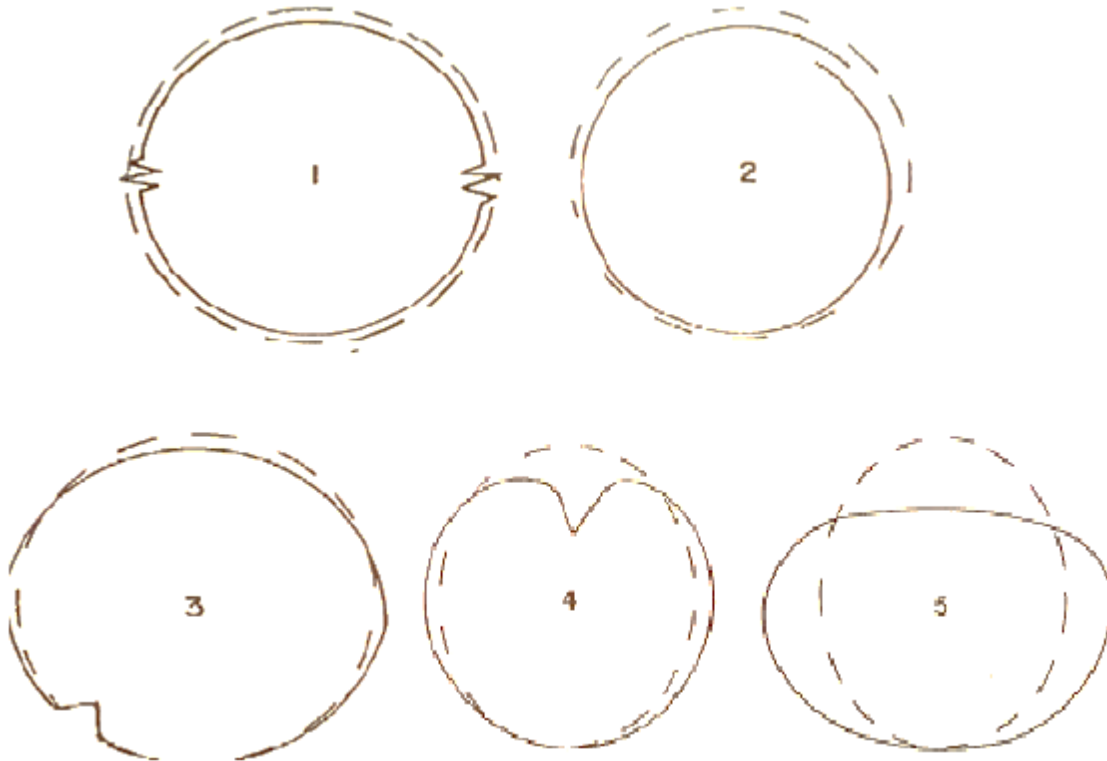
Les cinq modes de flambement des conduites flexibles enterrées.
